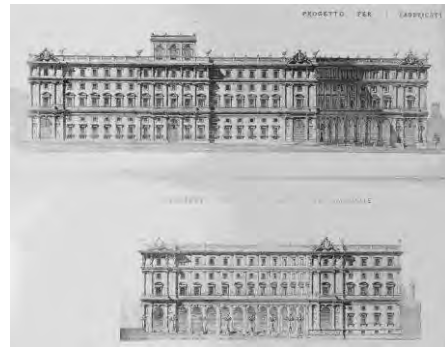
prospetti di sinistra su piazza Esedra versione con altana
